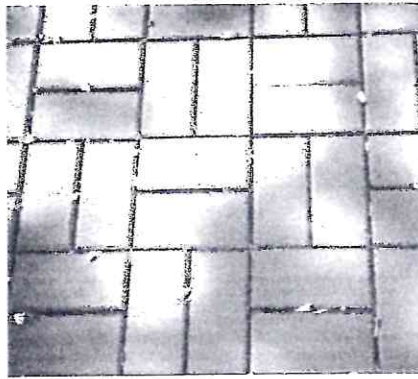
Piso intertravado assentamento tipo trama. Fonte: <https://lajestresmarias.com.br/project/paver-tradicional-pv09/>.
